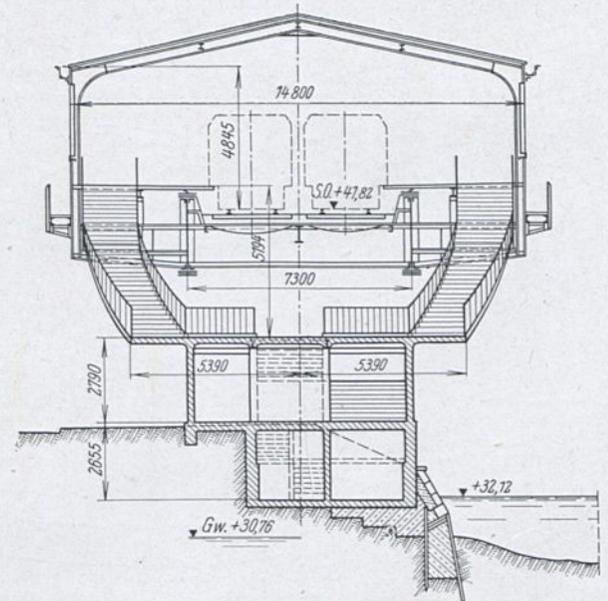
Schnitt c-c durch das Treppenhaus (s. Bild 9).
